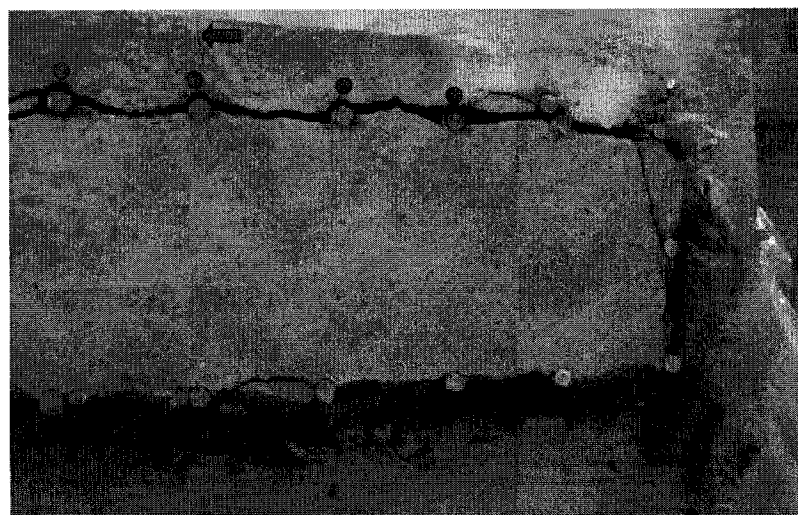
Coupe de S1 (selon Boucher-Proulx, 2008)
